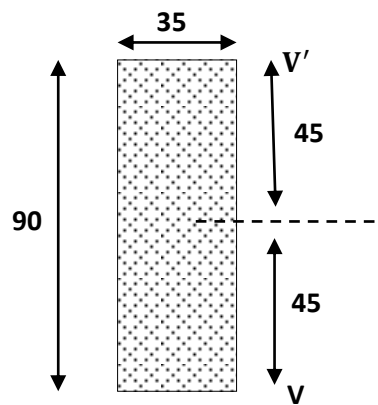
Les dimensions de la section de la poutre sans hourdis.
